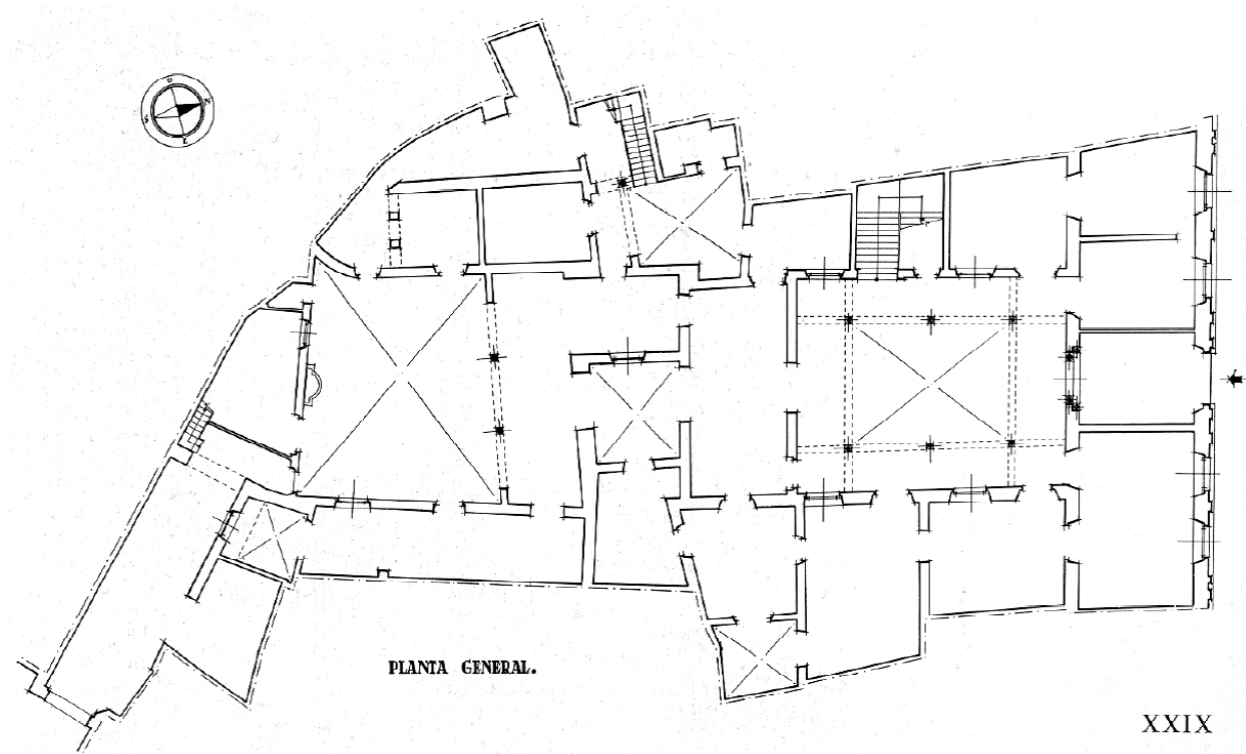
Planta de edificio en C/ Conde de Ibarra 18
